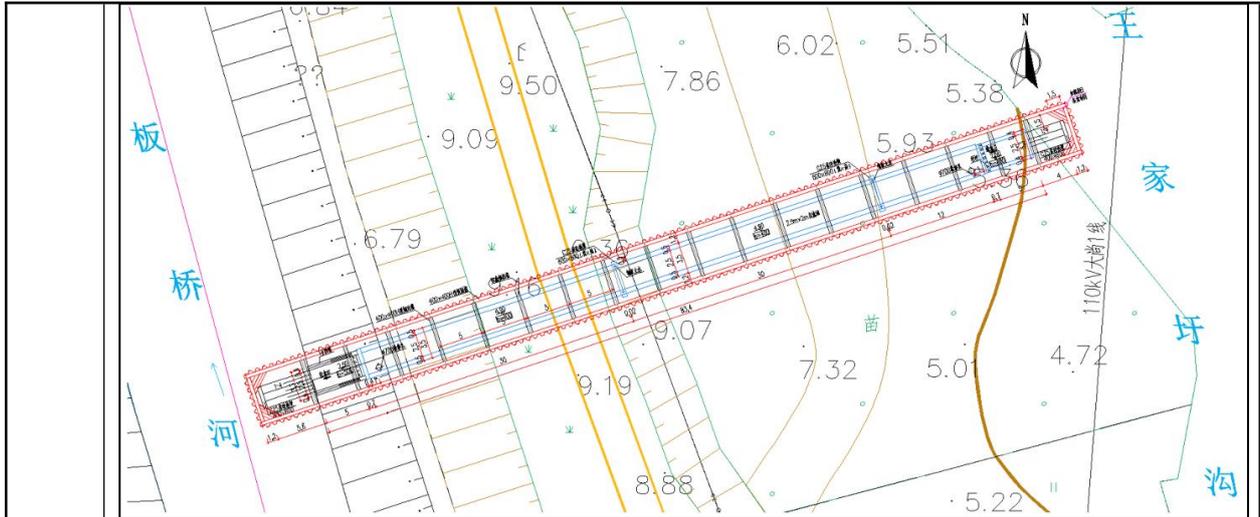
连通涵闸（赵家闸泵站位置）平面布置图
